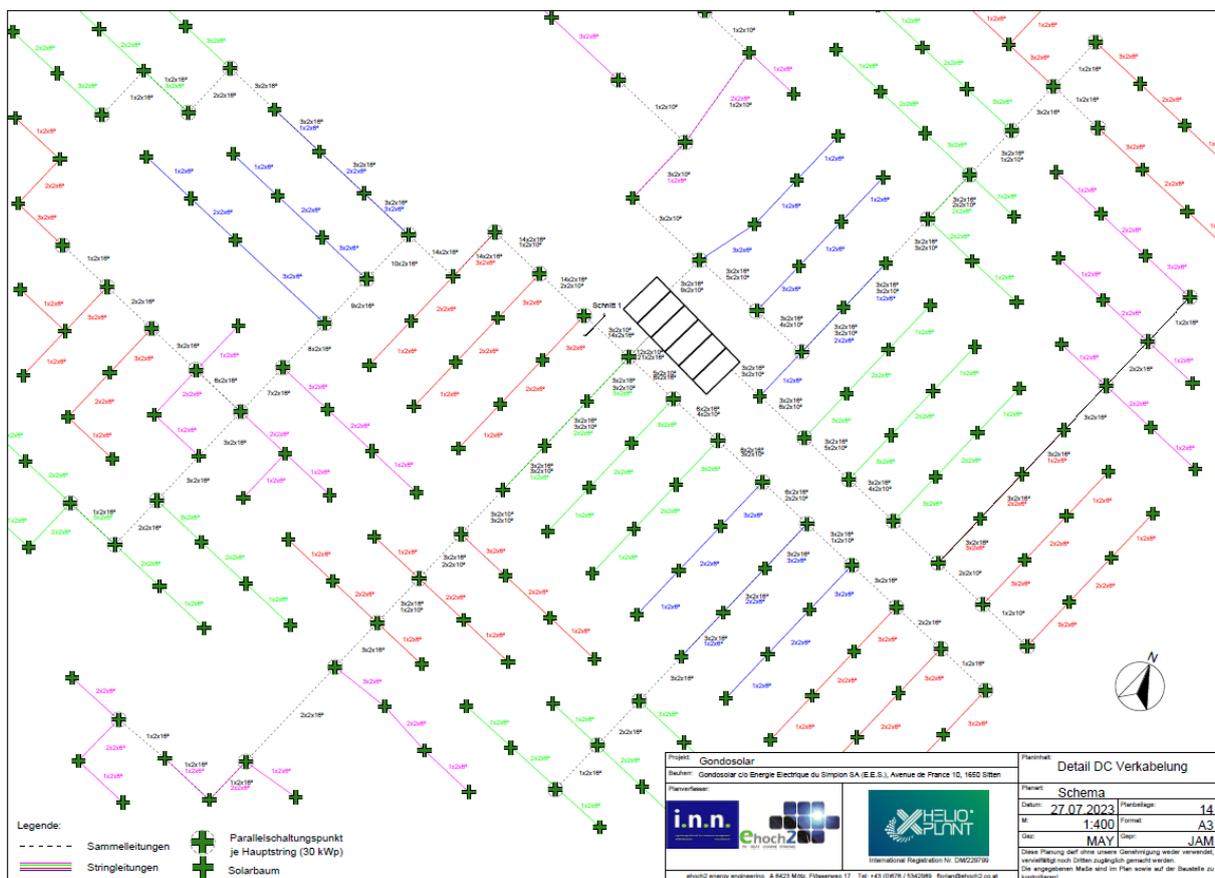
Kabelführung (vgl. Planbeilage 14)
